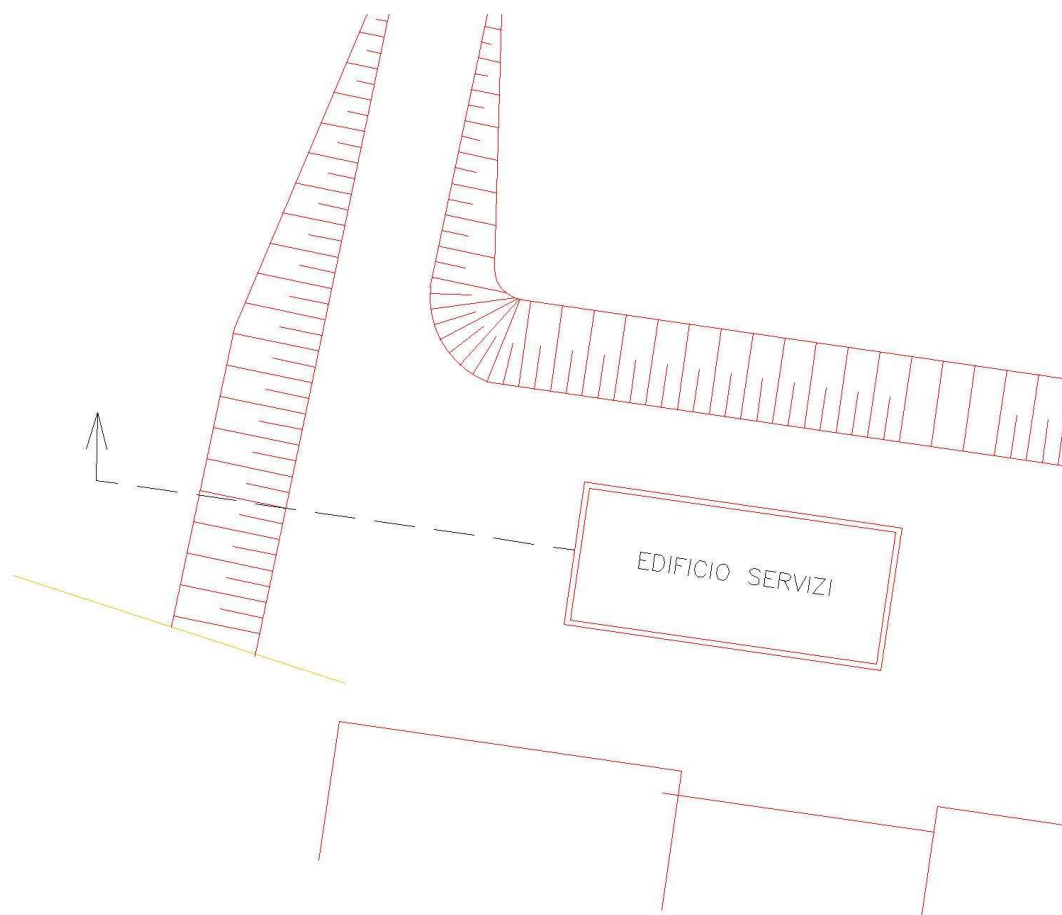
rilevato edificio servizi – indicazione sezione per analisi di stabilità
